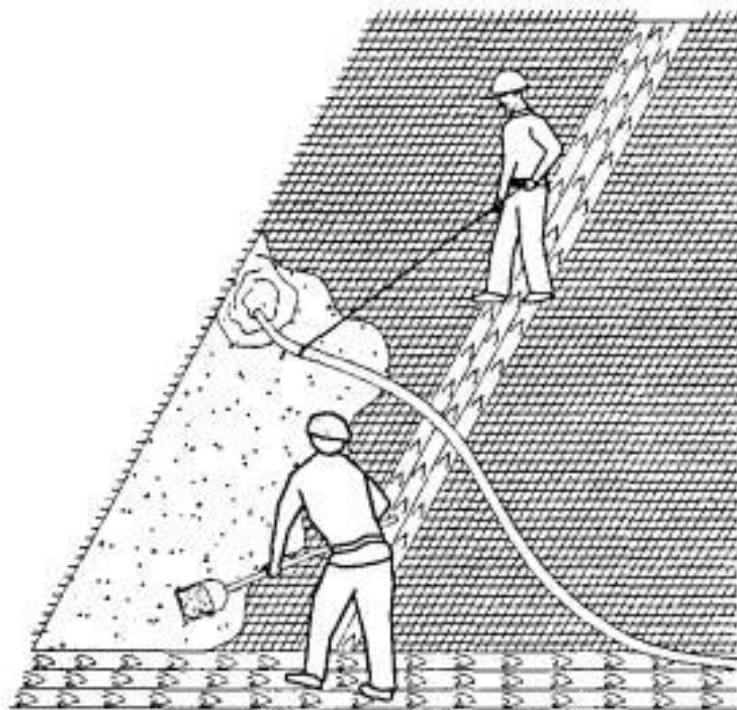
Производство работ по бетонированию плиты перекрытия
